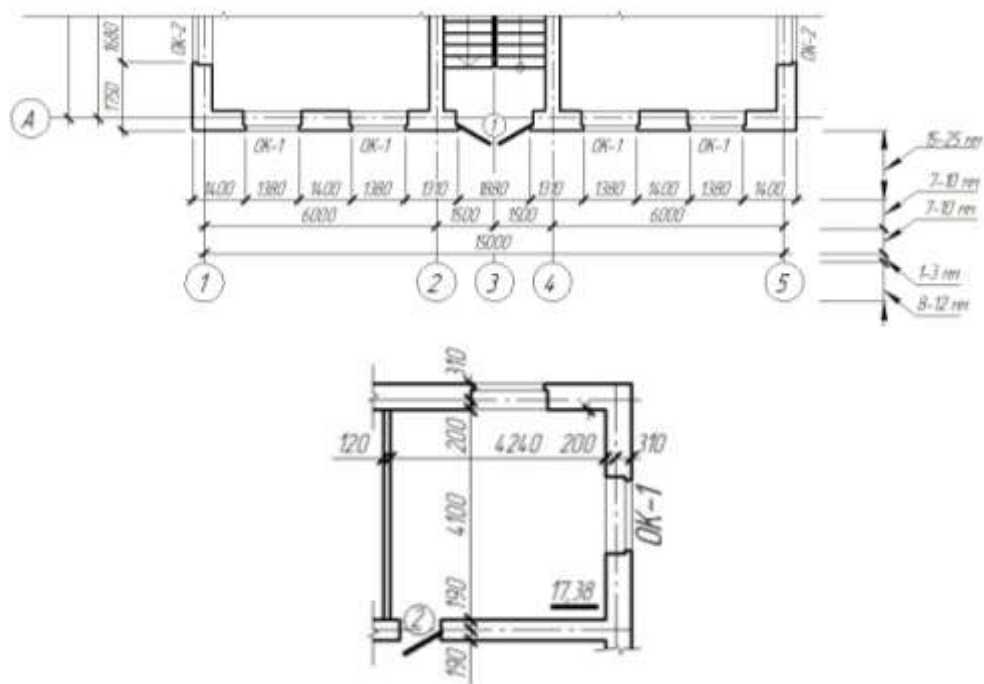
Требования к нанесению размеров на плане этажа: наружных и внутренних
